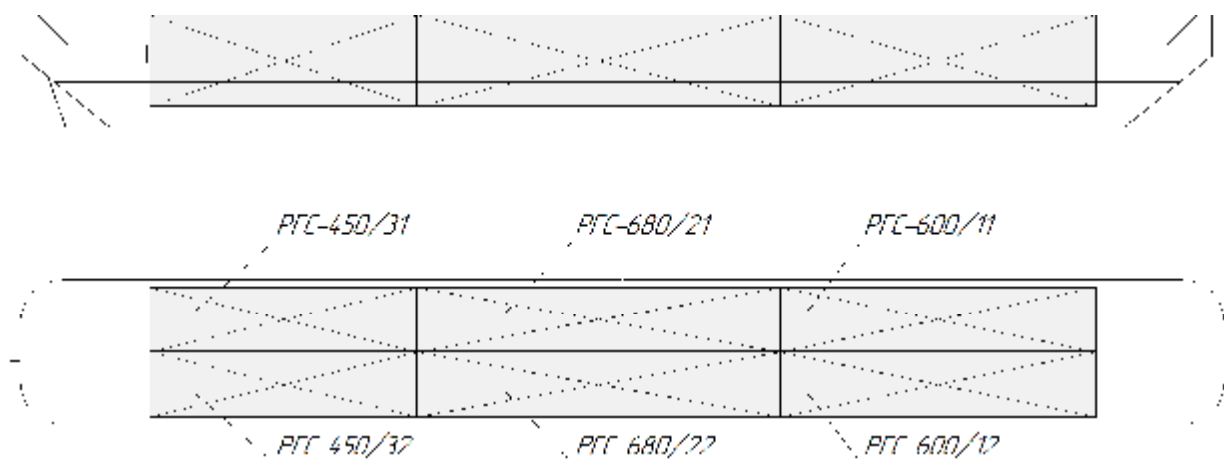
Эскиз общего вида резервуаров РГС-600, РГС-680, РГС-450
